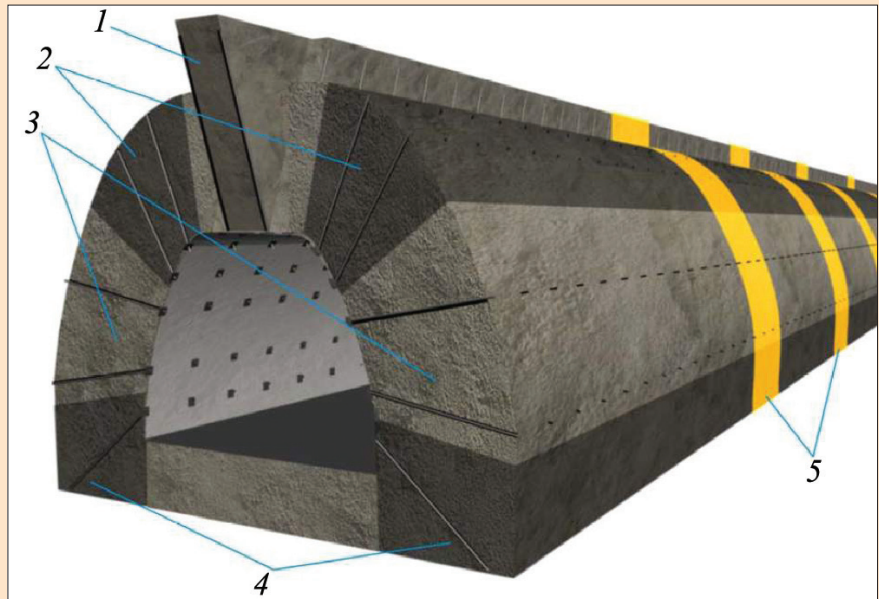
Элементы конструкции анкерной крепи: 1 и 2 – части перекрытия выработки силовая и подпорная; 3 – опоры перекрытия выработки; 4 – основание конструкции; 5 – защитные перемычки.
